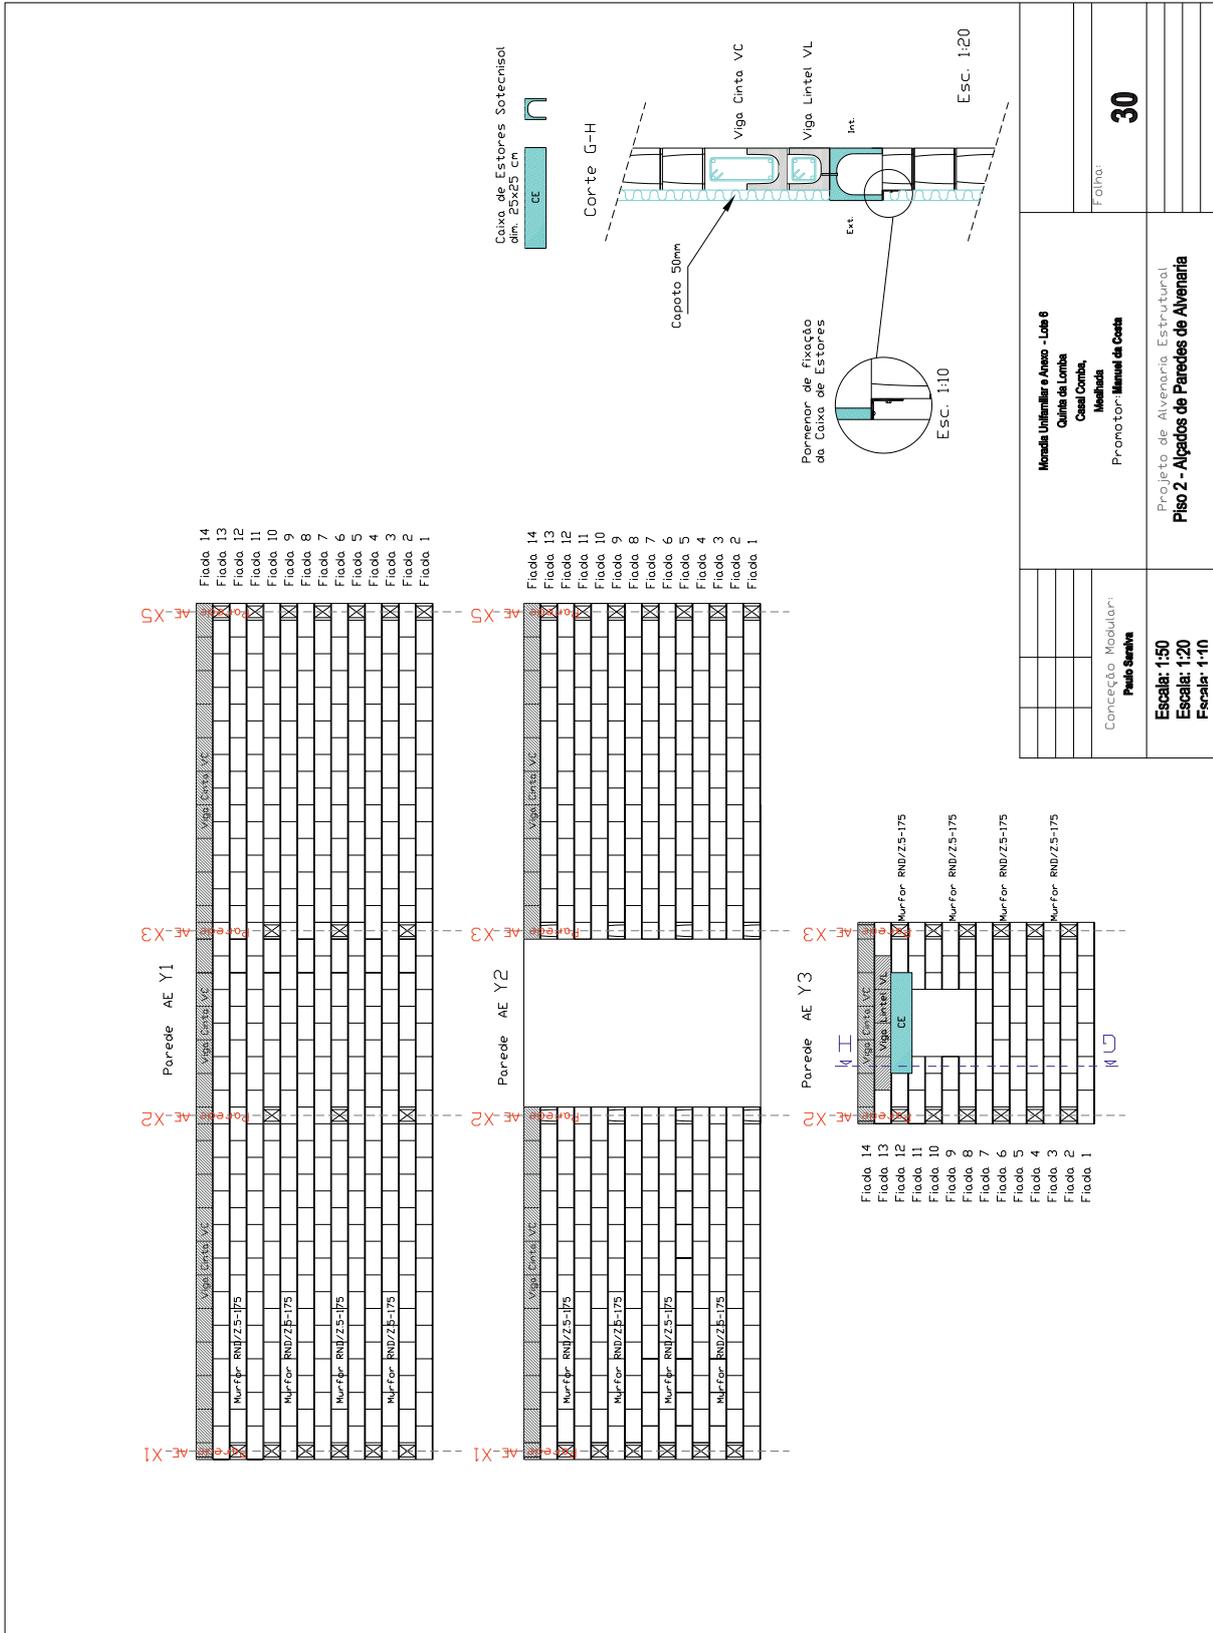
Alçado de paredes do eixo Y do 1º piso e pormenor em corte, da solução em AE
